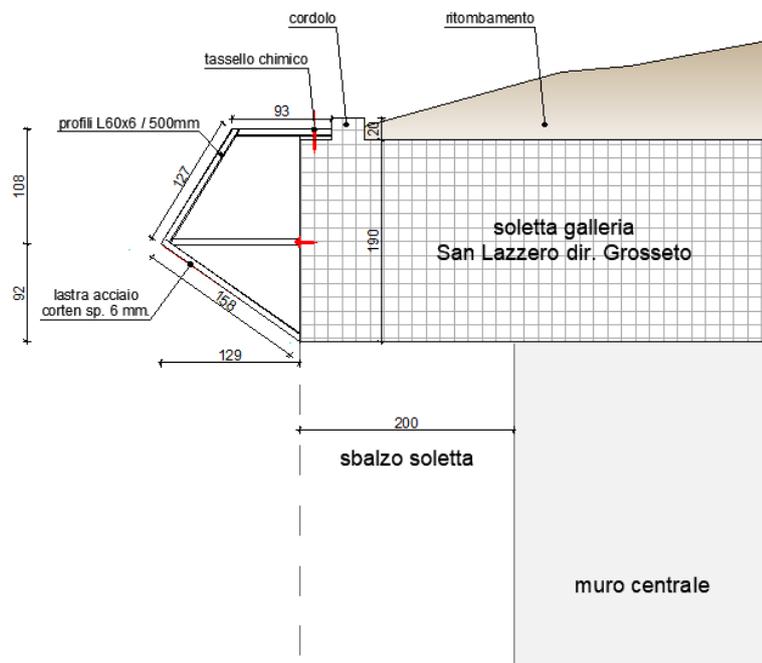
Sezione trasversale rivestimento imbocco galleria San Lazzerò
